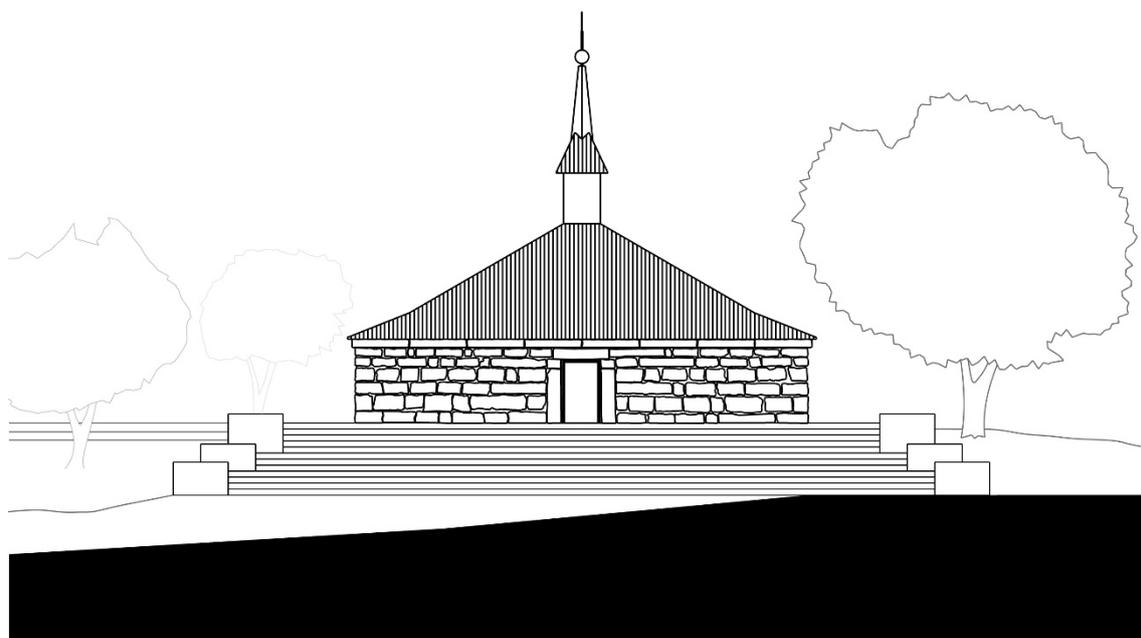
Planimetría con despiece del alzado norte del Real Nevero.
